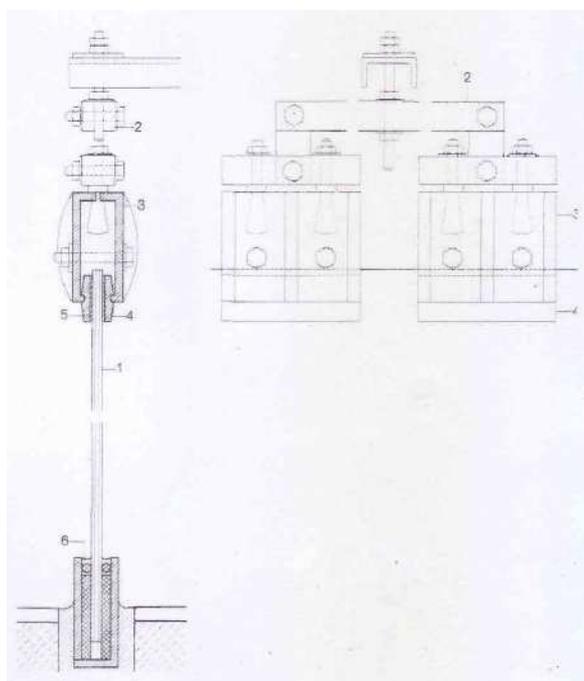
Esempio vetrata appesa con fermi a grappa - sezione verticale, sezione orizzontale
